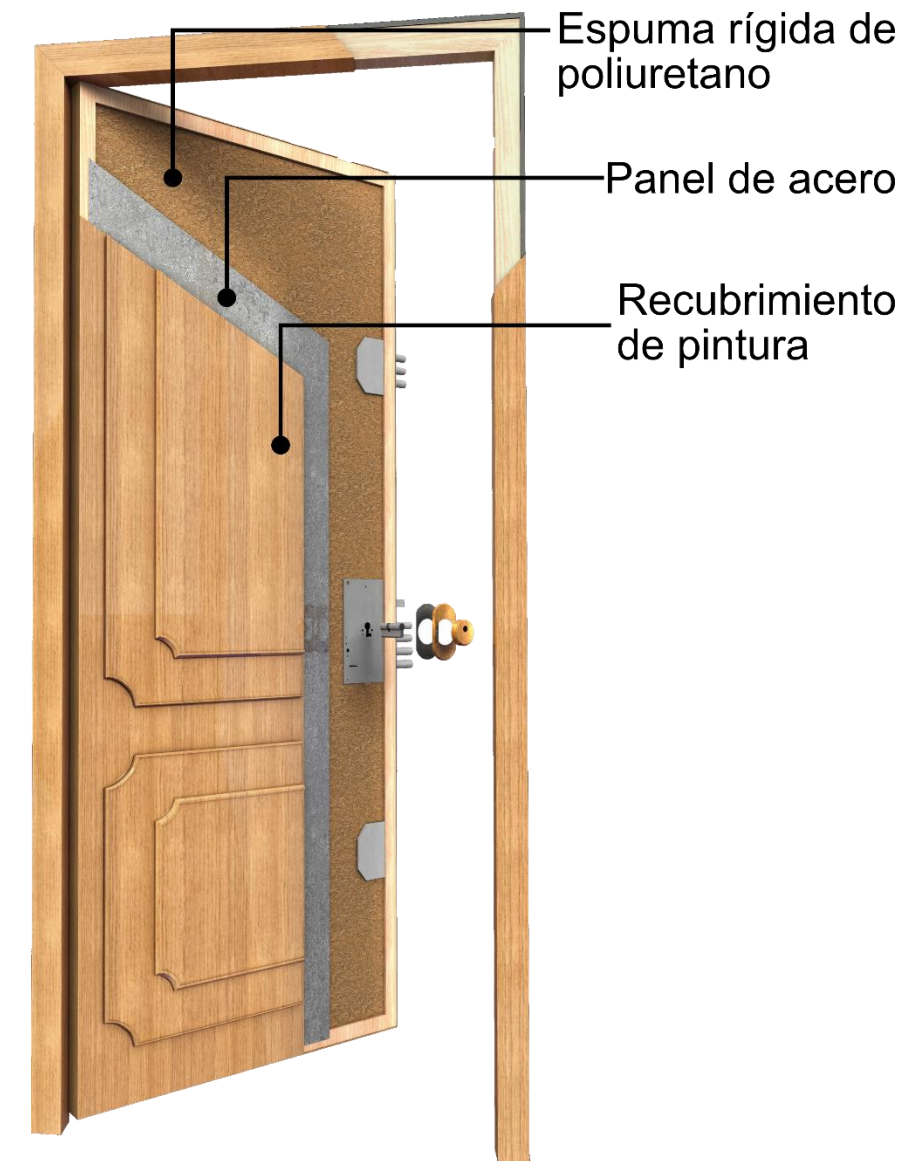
Detalle constructivo de puertas del proyecto. Fuente Roconsa.com.
